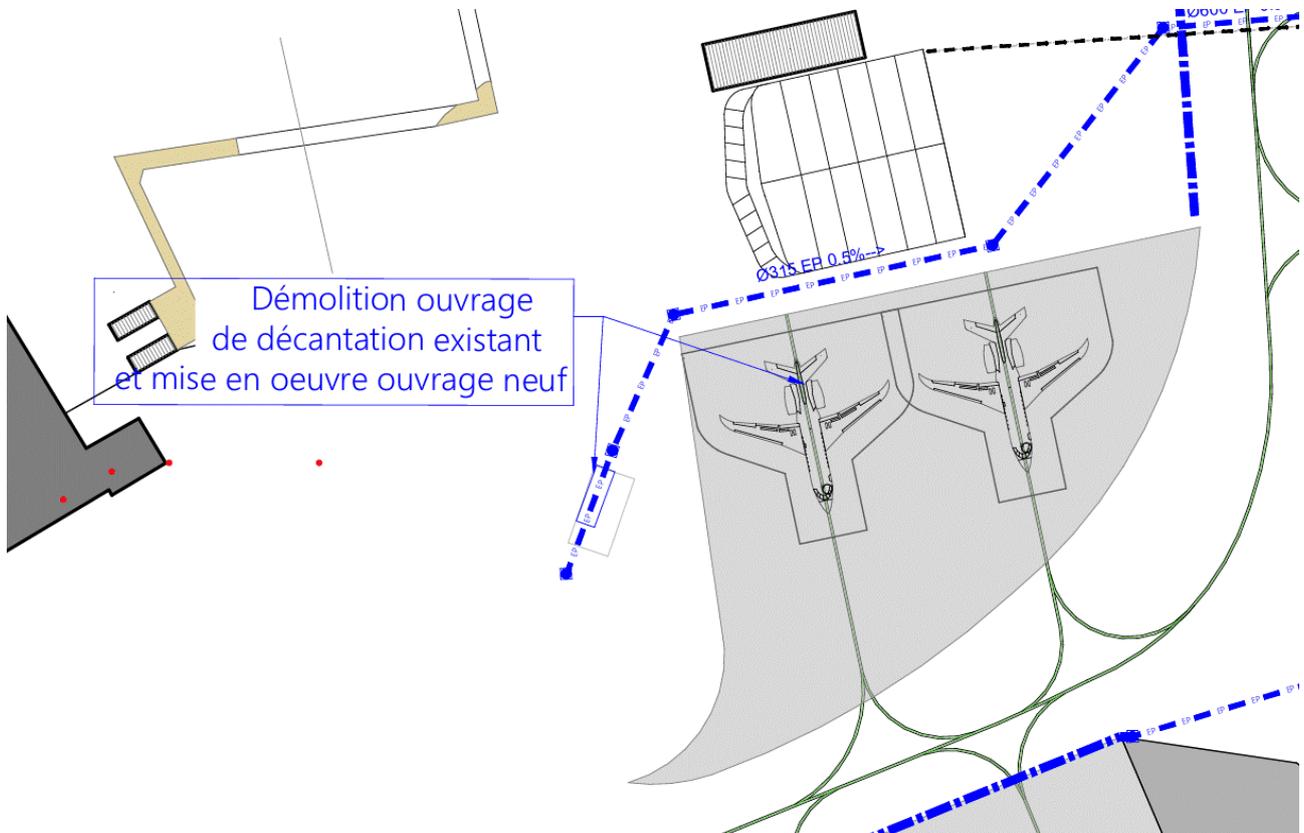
Localisation du décanteur existant et de sa nouvelle zone d'implantation
